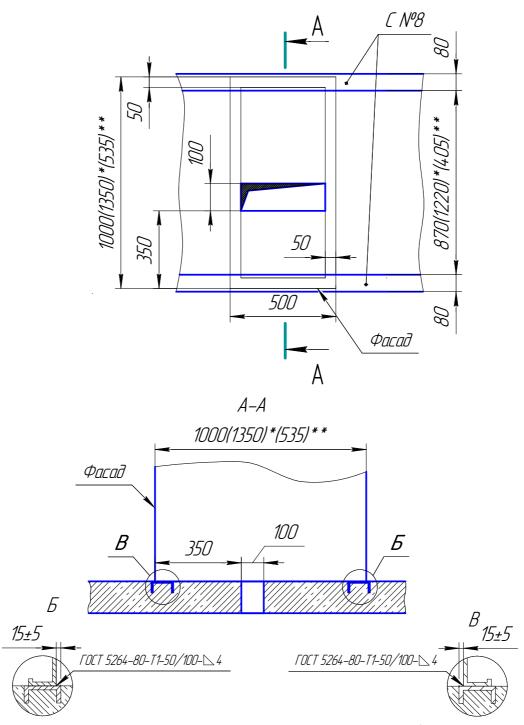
Установка шкафов РУНН на фундамент и ввод кабелей (*- для КТП 1600-3150 кВА)
